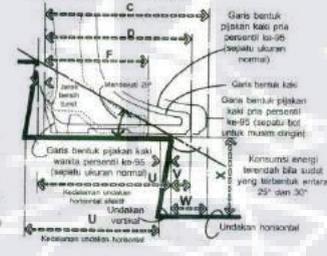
DETAIL HUBUNGAN UNDAKAN VERTIKAL DAN HORIZONTAL/STUDI ANTROPOMETRIK SKEMATIK
